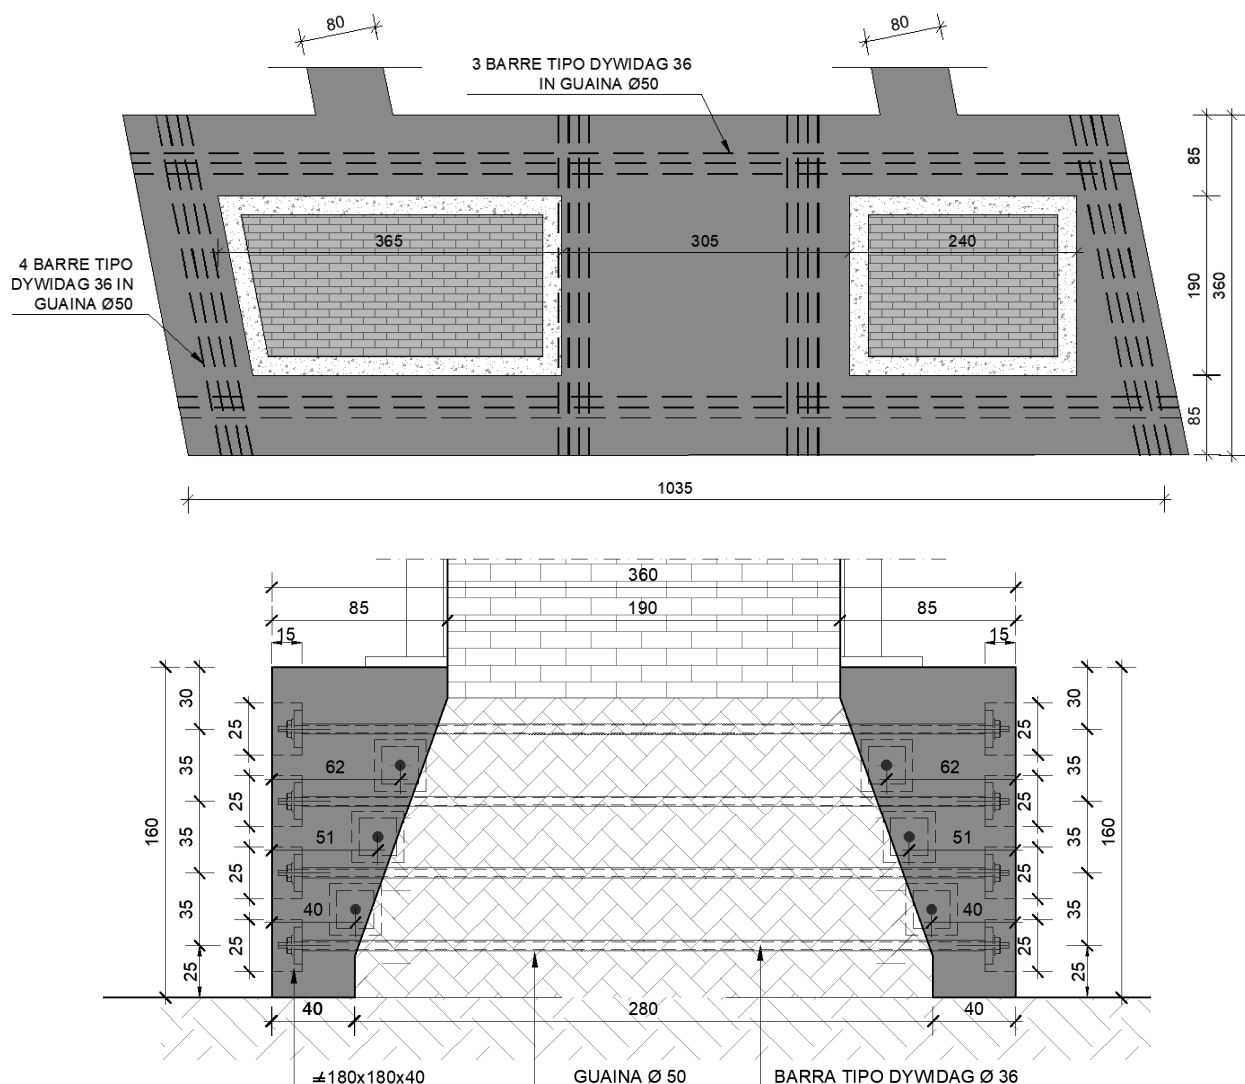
Adeguamento della Soluzione PD di riferimento: consolidamento strutturale delle fondazioni del ponte in muratura – Pianta e Sezione
